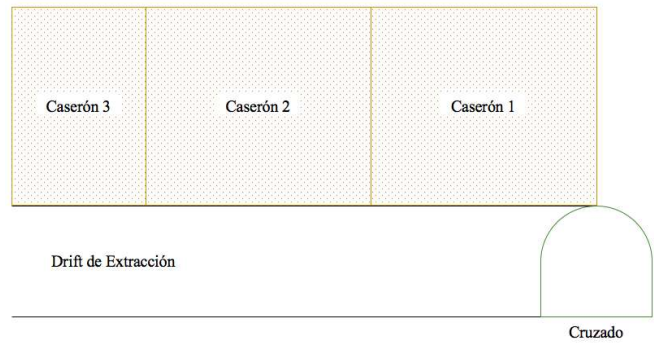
Vista en perfil, secuencia constructiva Mina Y.
